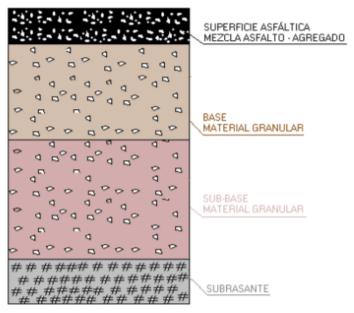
Esquema pavimento asfáltico Fuente: (Valenzuela, 2003).
